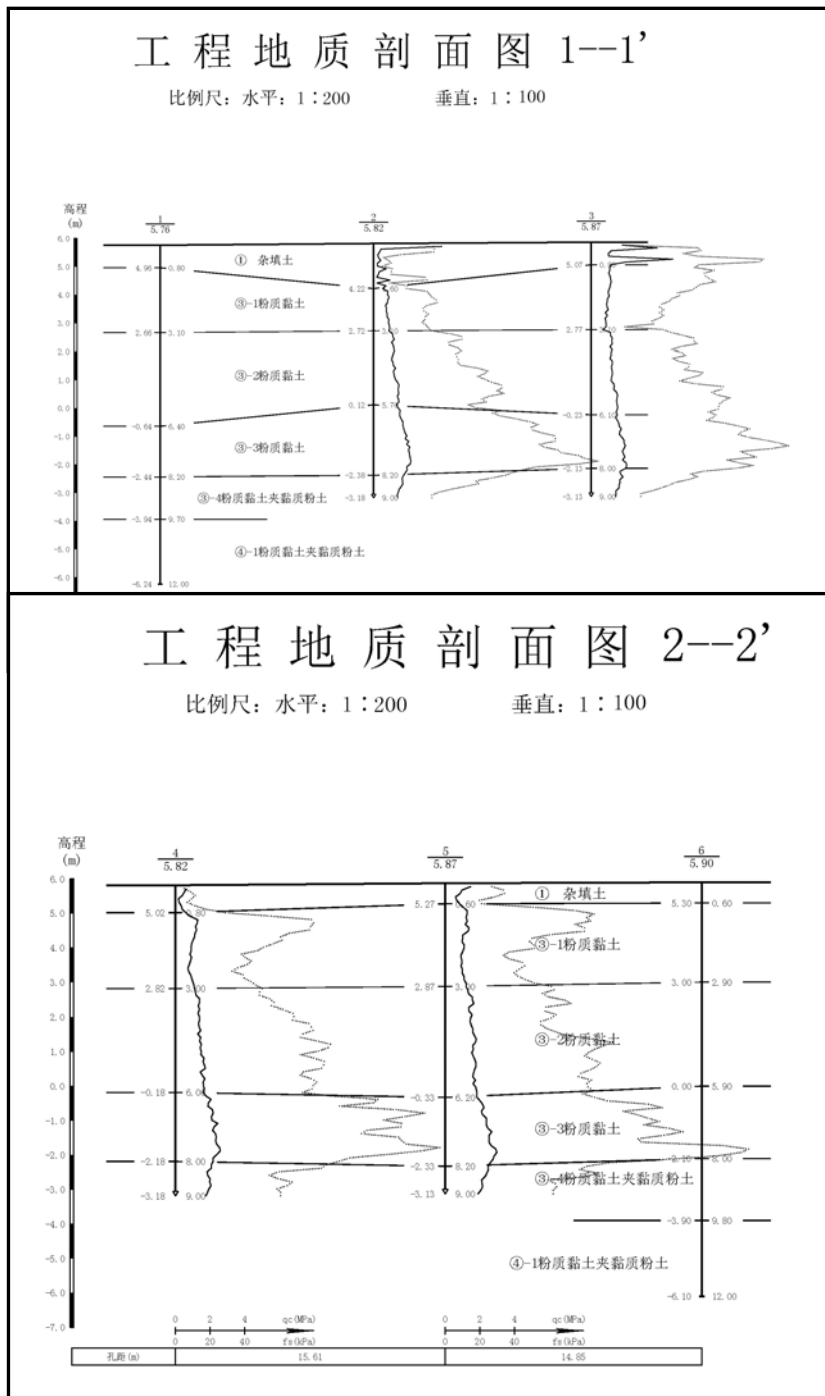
1 本项目所在区域勘测点工程地质剖面图
